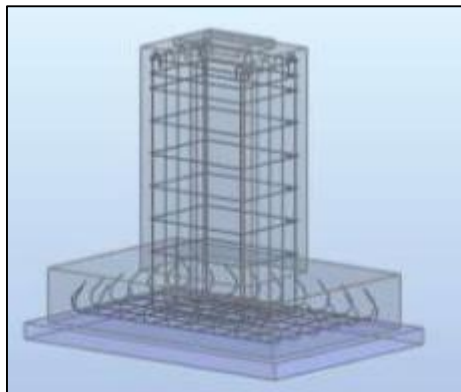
Vue 3D du ferrailage des semelles.
